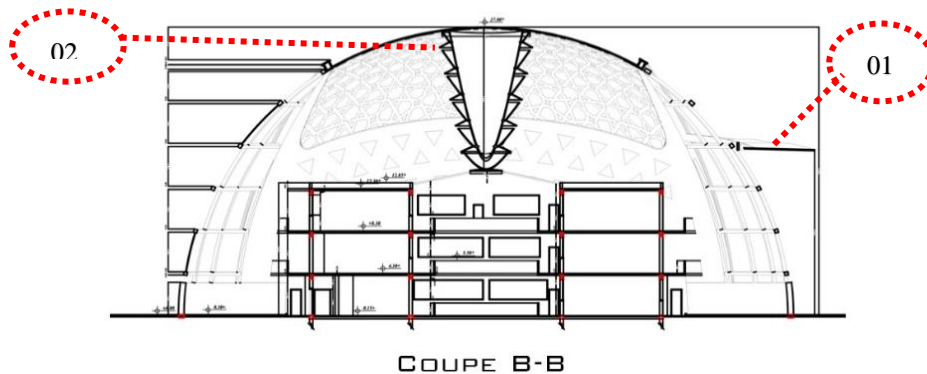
65: coupe B-B ECH / 1/500. Source : Auteur.
